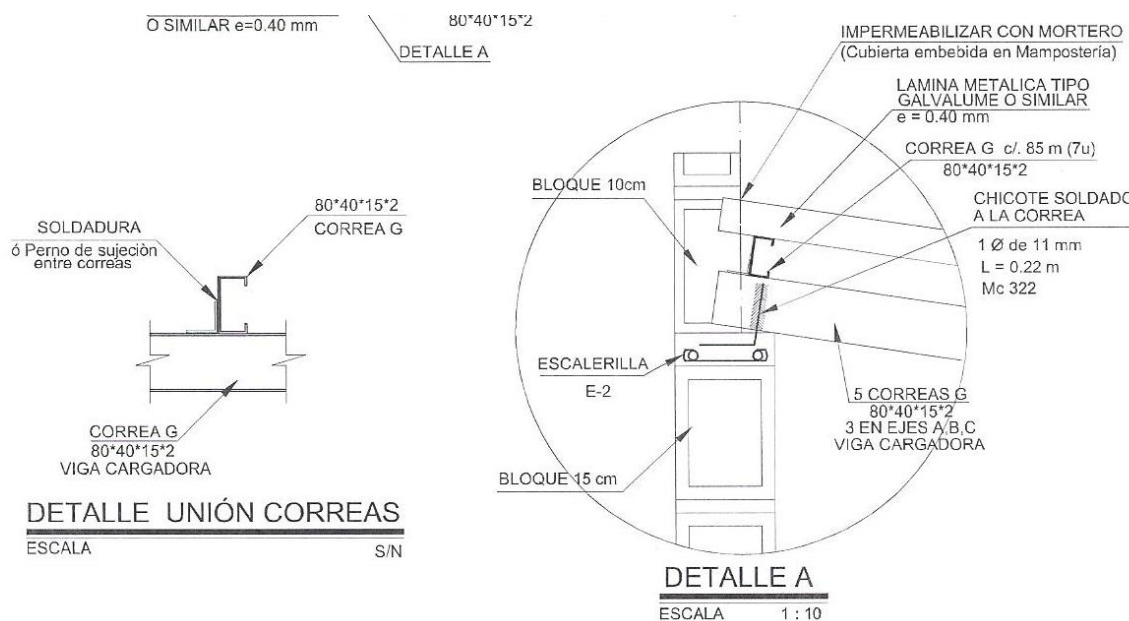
Detalle de la disposición de la planta de cubierta desmontable
